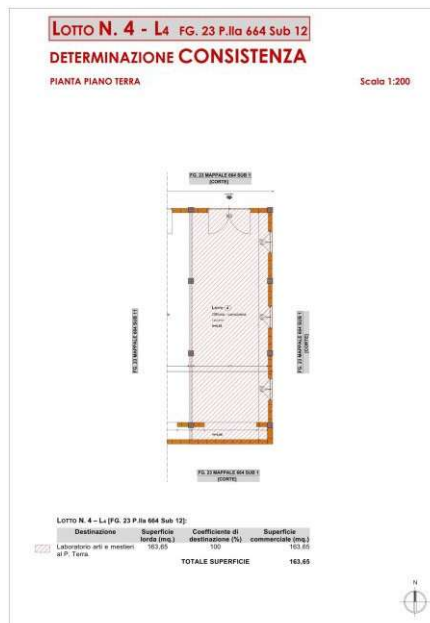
Determinazione consistenza Lotto L₄ (ALL. 11).
